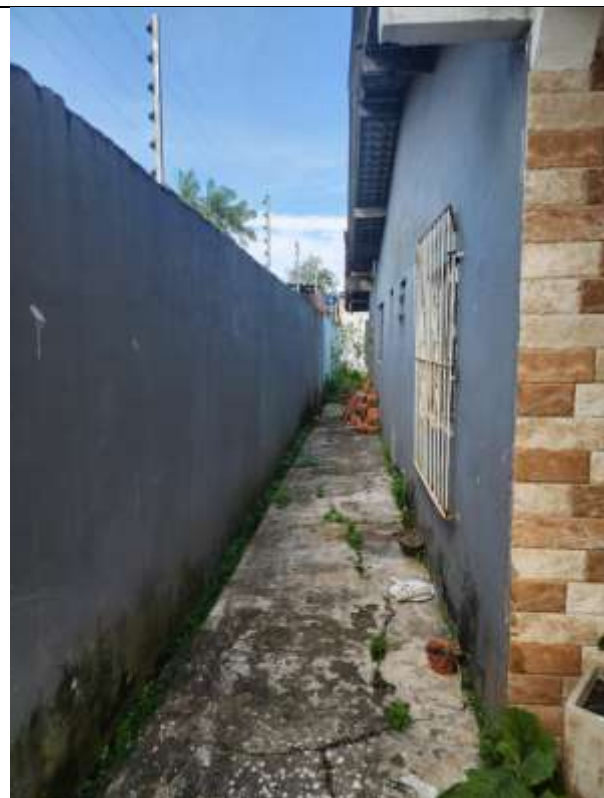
Fissura no solo e presença de limo e vegetação
